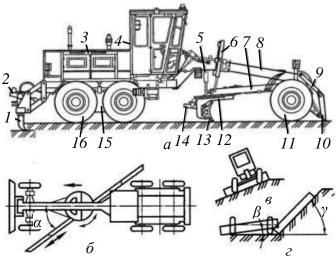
Автогрейдер класса 140: а – общий вид; б – схема поворота отвала в плане; в – схема бокового наклона колес; г – схема бокового выноса отвала; 1 – кирковщик; 2, 5, 6, 9, 14 – гидроцилиндр; 3 – двигатель; 4 – кабина; 7, 8 – тяговая и основная рамы; 10 – бульдозерный отвал; 11, 16 – колеса, 12 – поворотный круг; 13 – грейдерный отвал; 15 – задний мост
